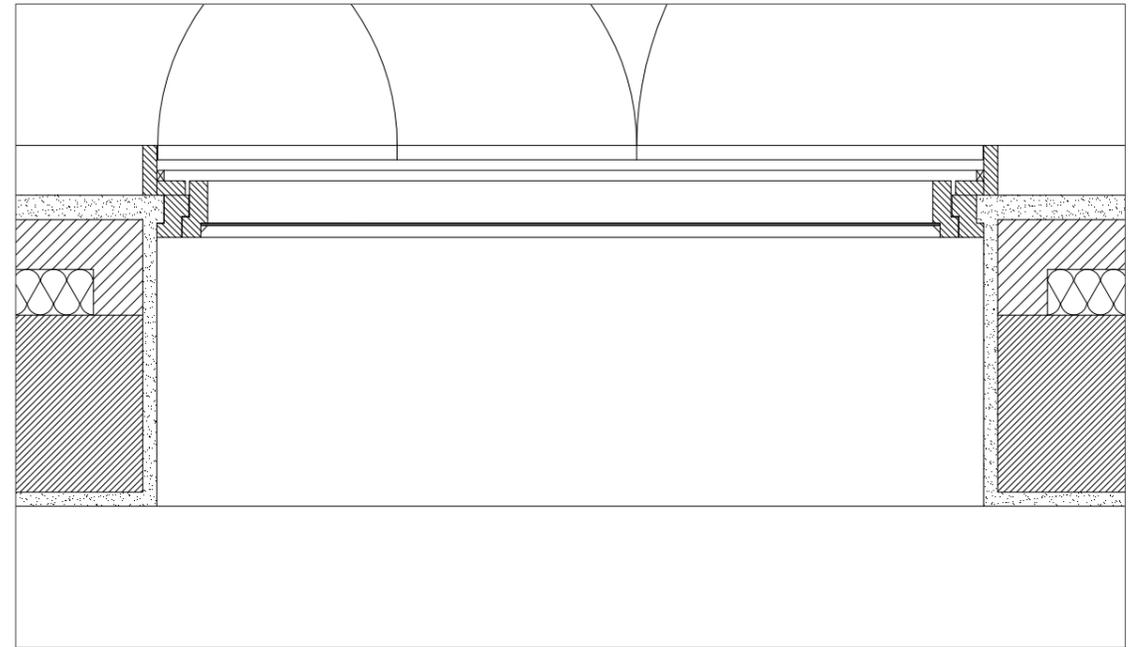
Planta do Vão-tipo — Desenho Original | Escala 1:10
